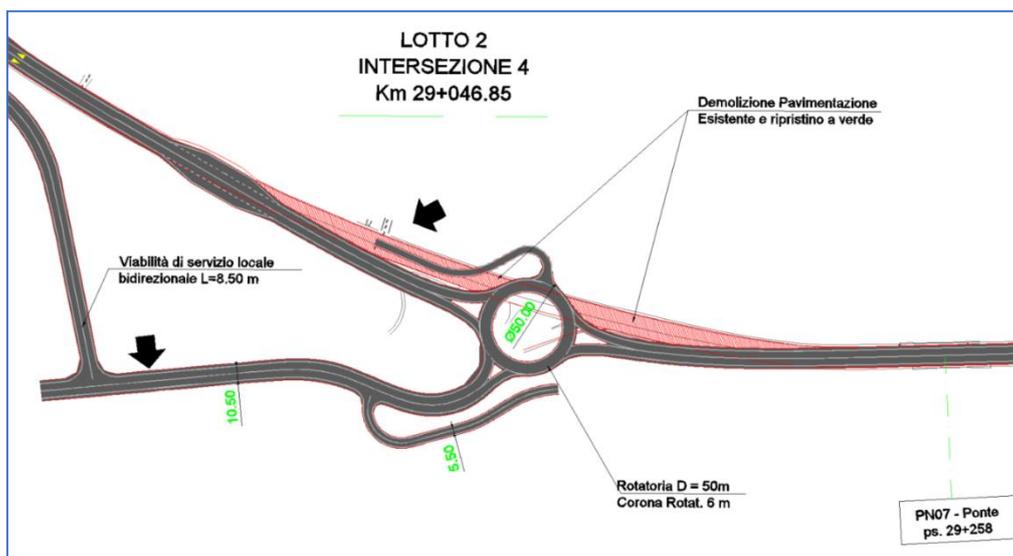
Intersezione 4 - Km 29+046 – Progetto
